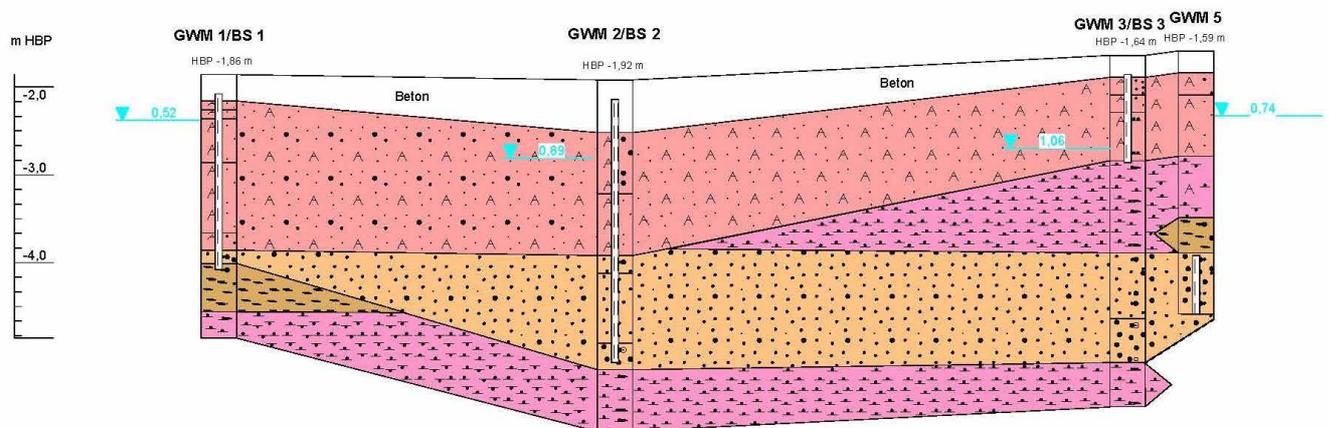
Untergrundaufbau im südlichen, schleinahen Geländebereich (GWM 1-3)
